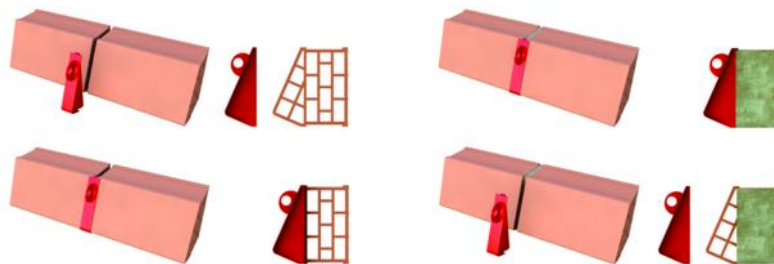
Design de Bloco Termodissipador – BT: a montagem é igual à dos tijolos tradicionais; utilizam uma peça especial – espaçador de junta – para corrigir a posição do bloco e definir com precisão a dimensão da junta. A argamassa fica na face retangular do bloco, deixando a face triangular completamente limpa.
